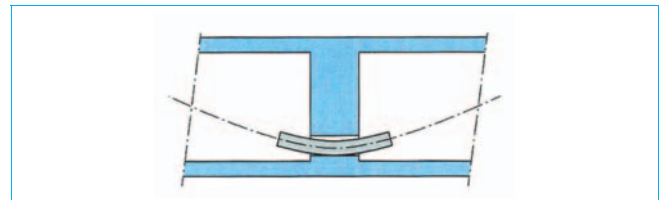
Déviateur dans une entretoise existante ou rapportée
